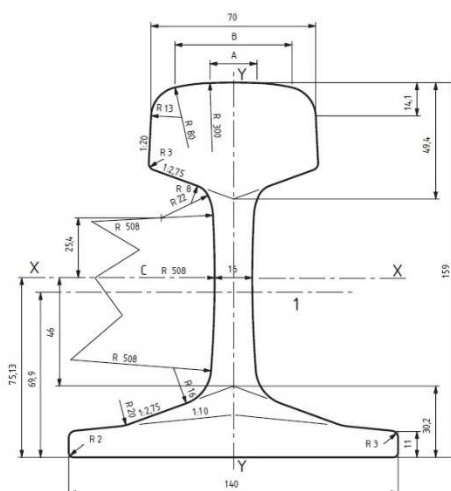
Secção transversal do carril UIC54 (EN 13674-1, 2002).
